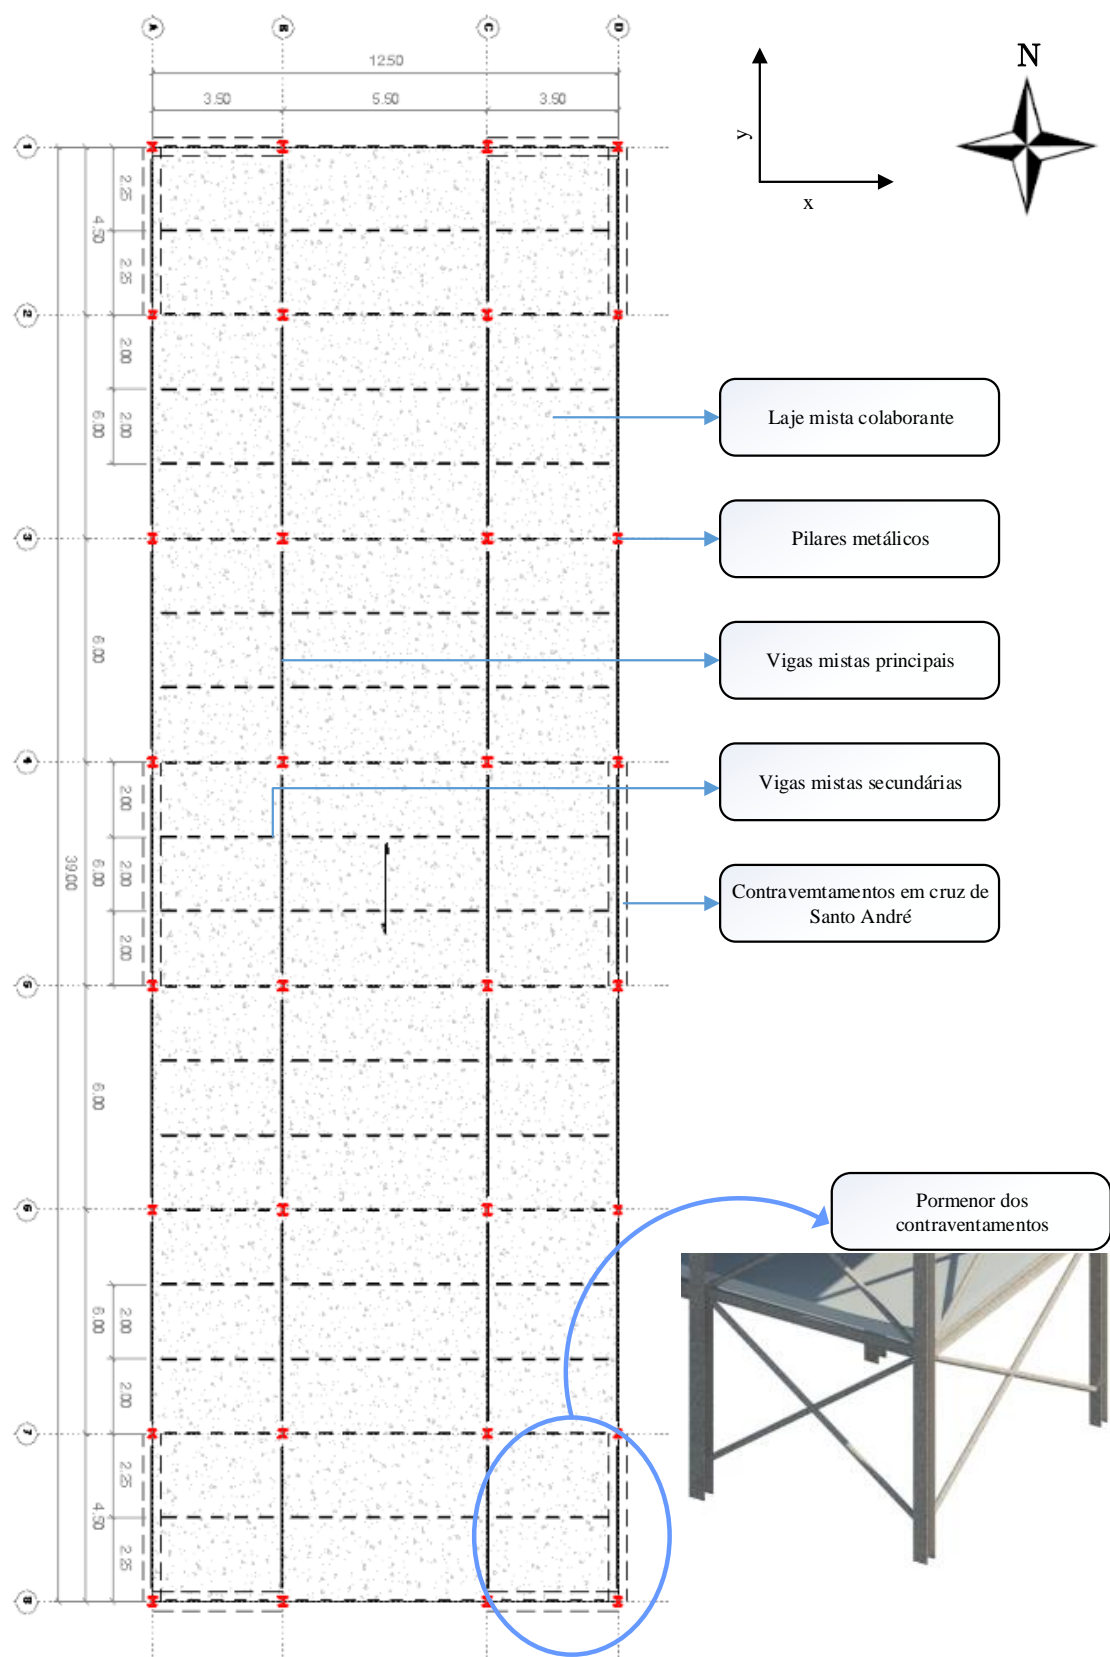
Planta estrutural do edifício referente ao piso tipo.
